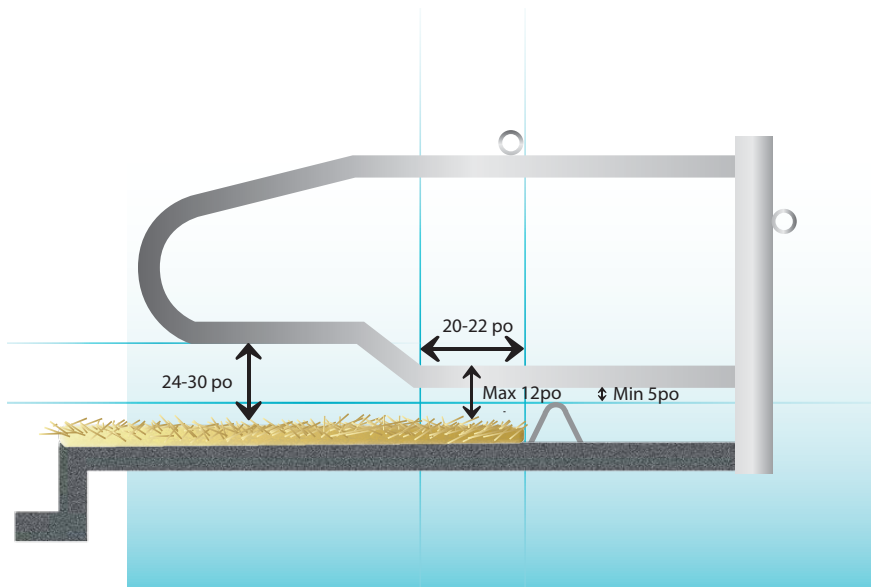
DIVISION D'UNE LOGETTE EN STABULATION LIBRE
